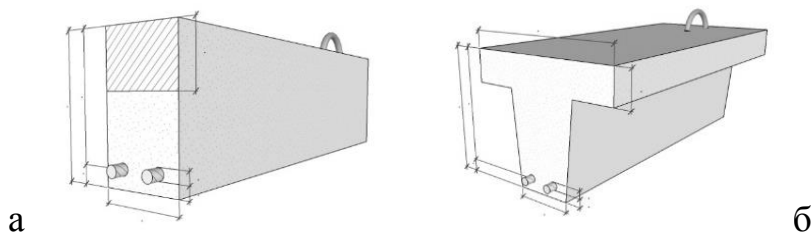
Прямоугольное (а) и тавровое (б) сечения железобетонных элементов
